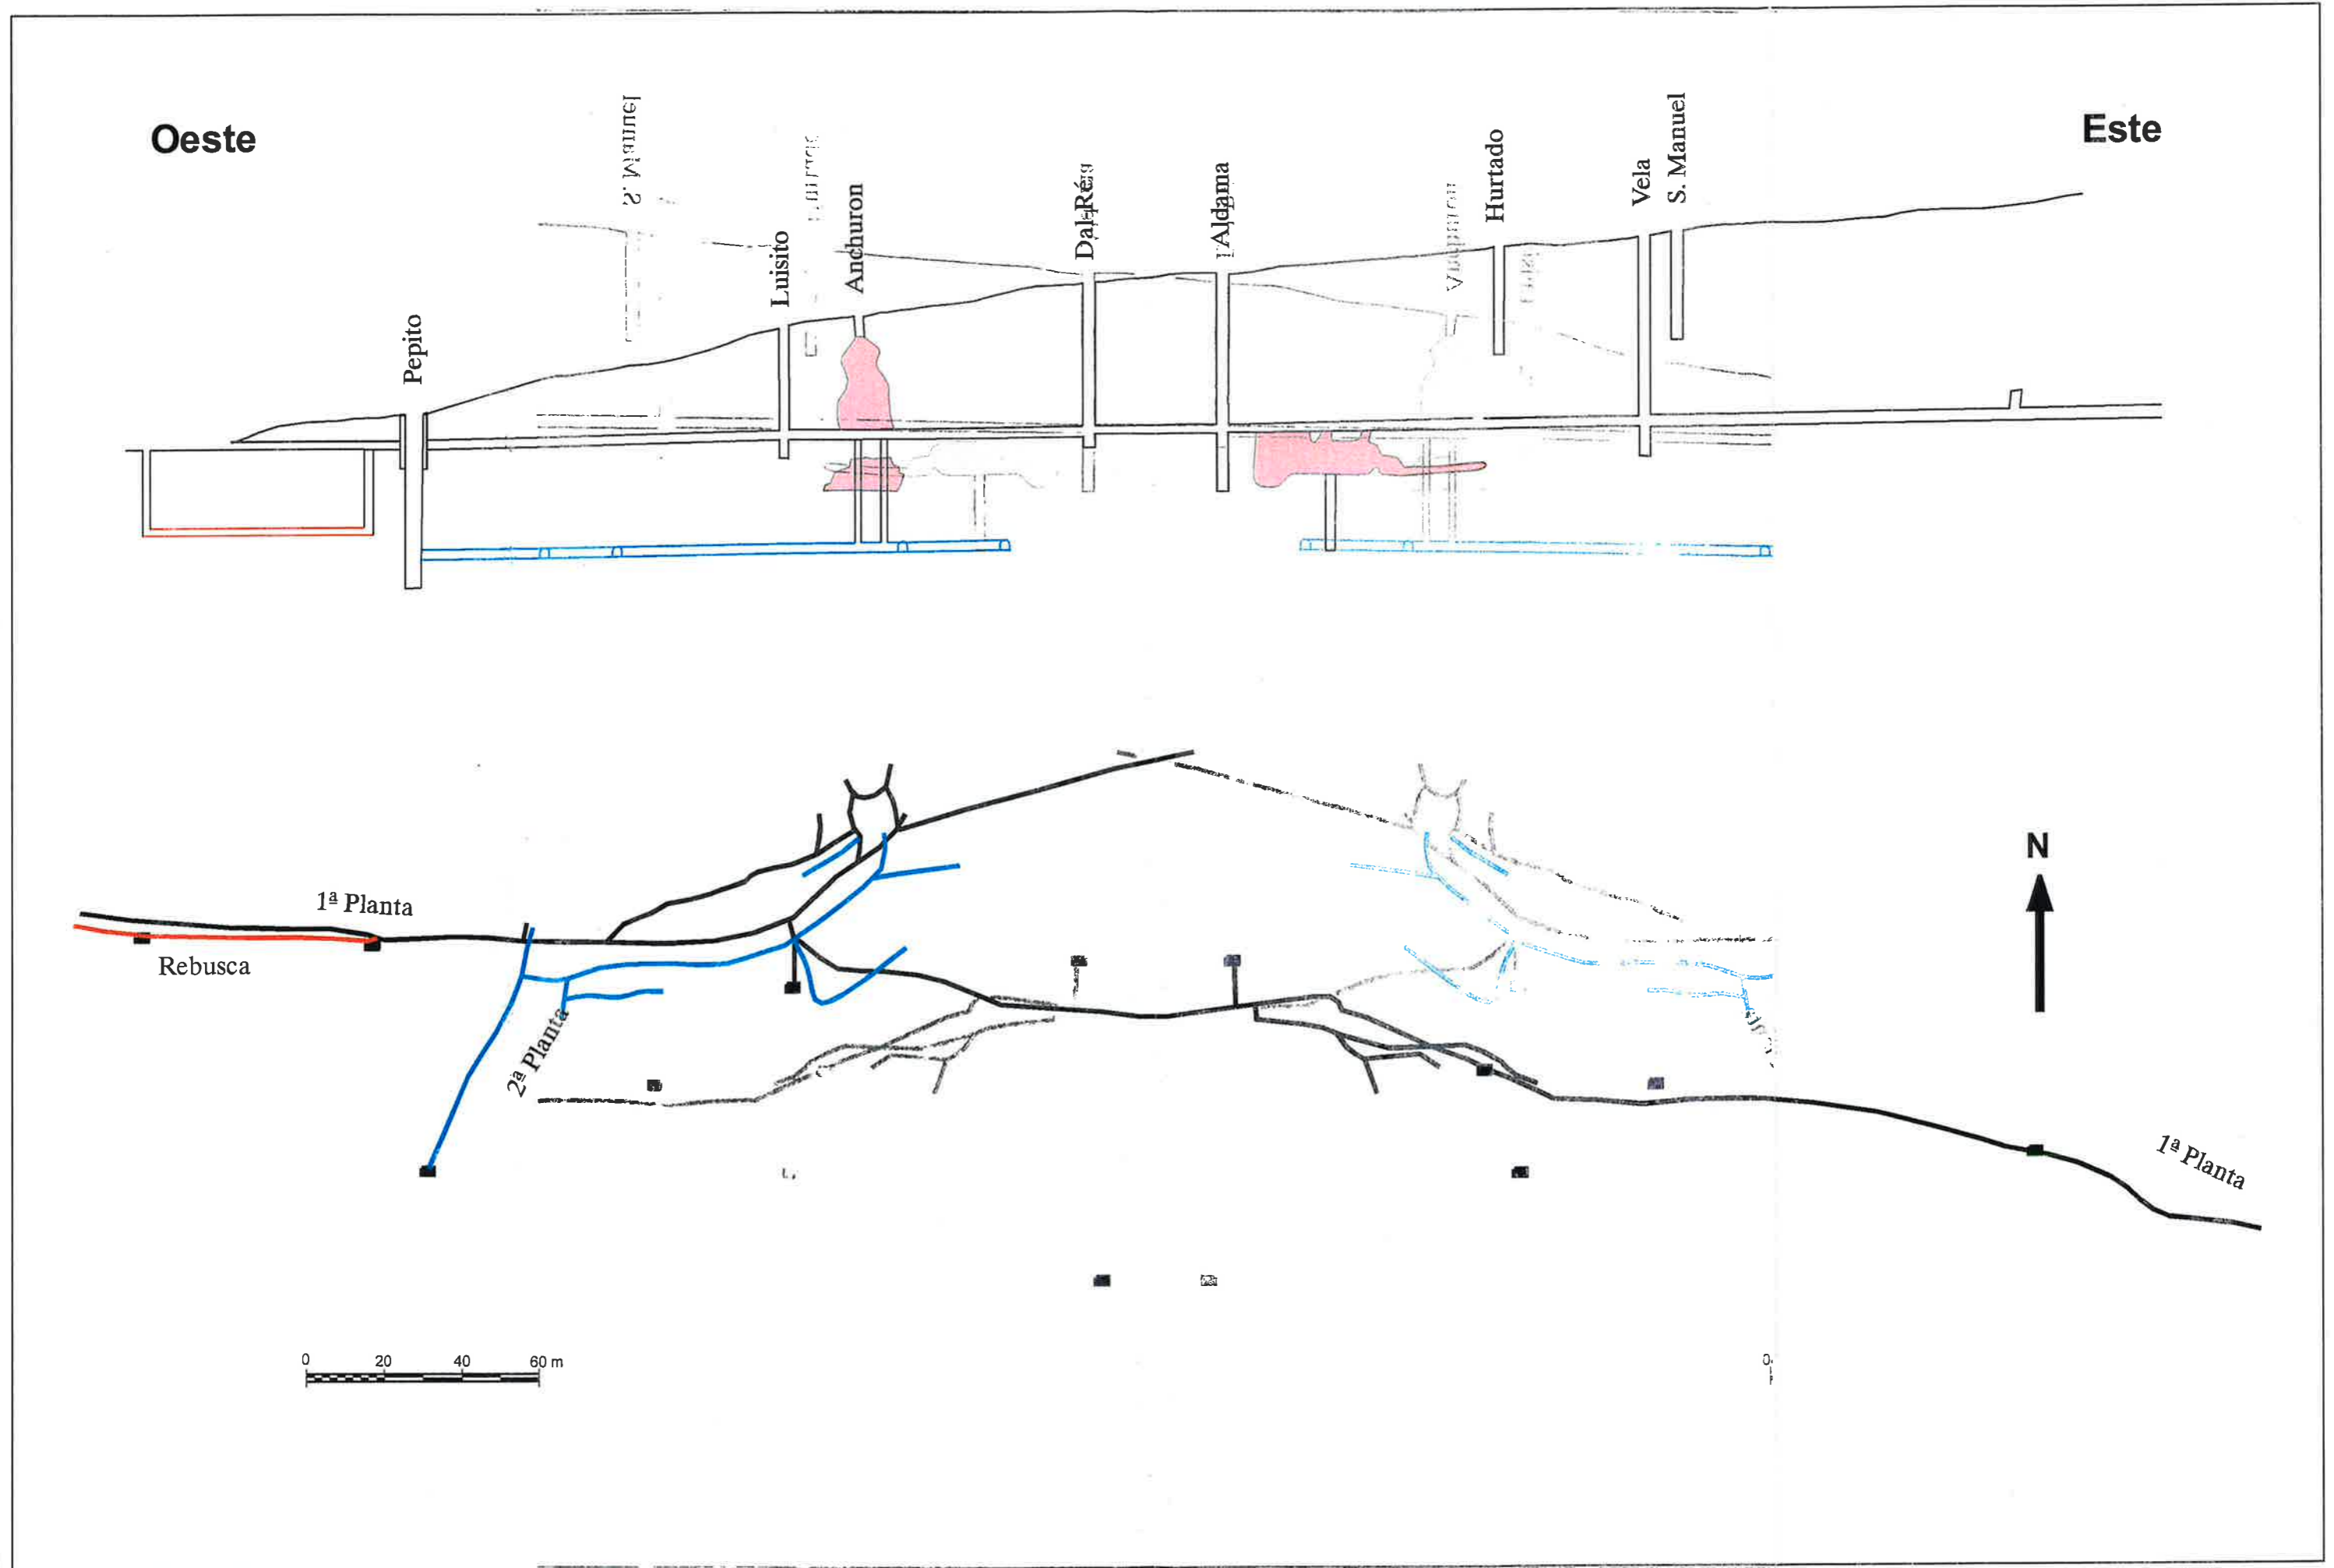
Proyección longitudinal y en planta de las labores mineras de la Mina Villalba (Mestanza)
